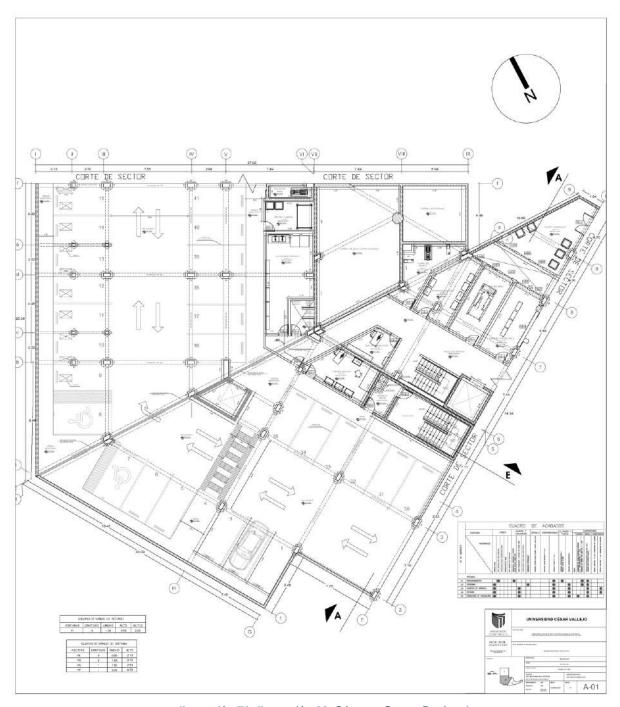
Ilustración 69. Sótano - Sector B - Arquitectura
